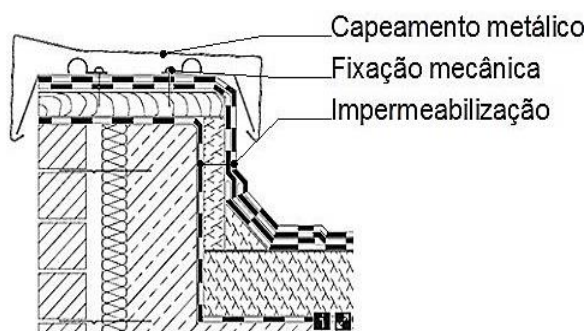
Pormenor de platibanda [adaptado de w₂₀]
